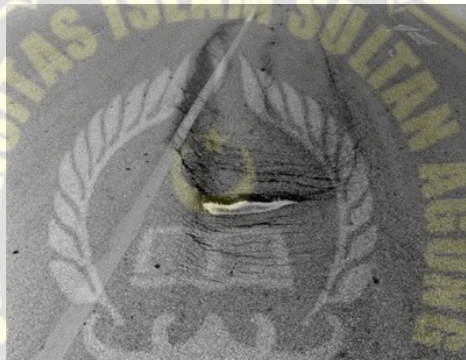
4 Retak Sambungan Bahu Dan Perkerasan (*Edge Joint Crack*)
